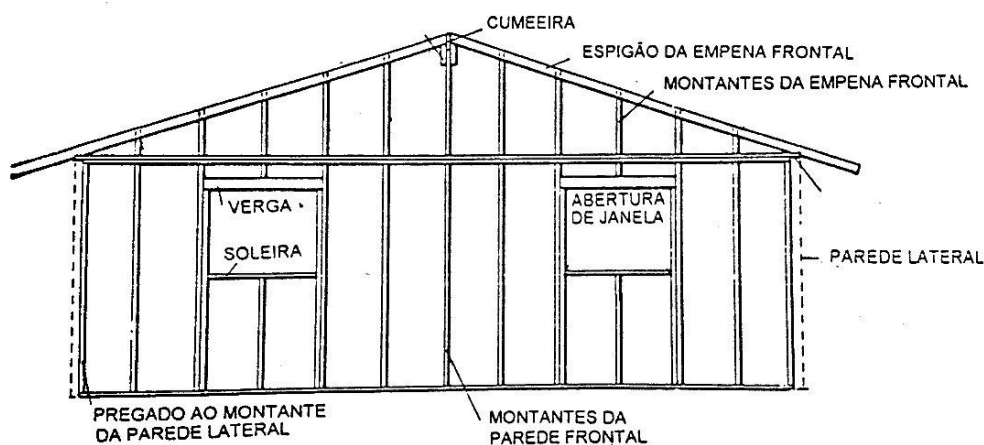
Vista lateral da junção de uma parede com o telhado no sistema plataforma
